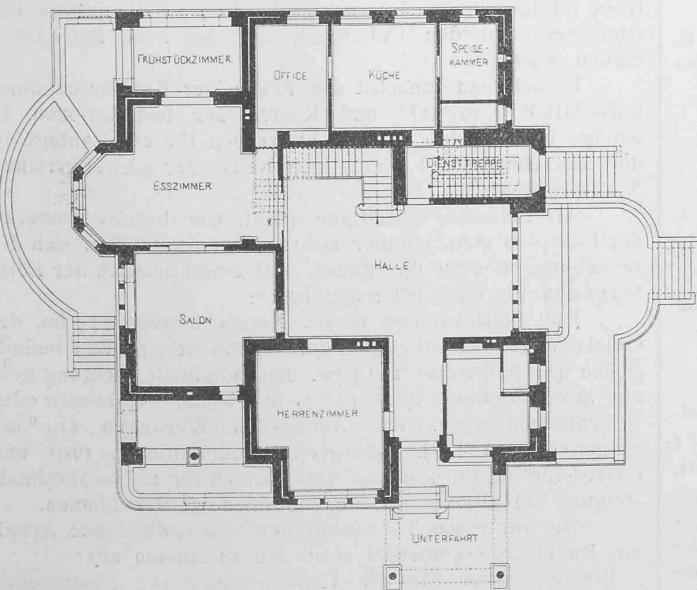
Grundriss vom Erdgeschoss. — Masstab 1:300.
